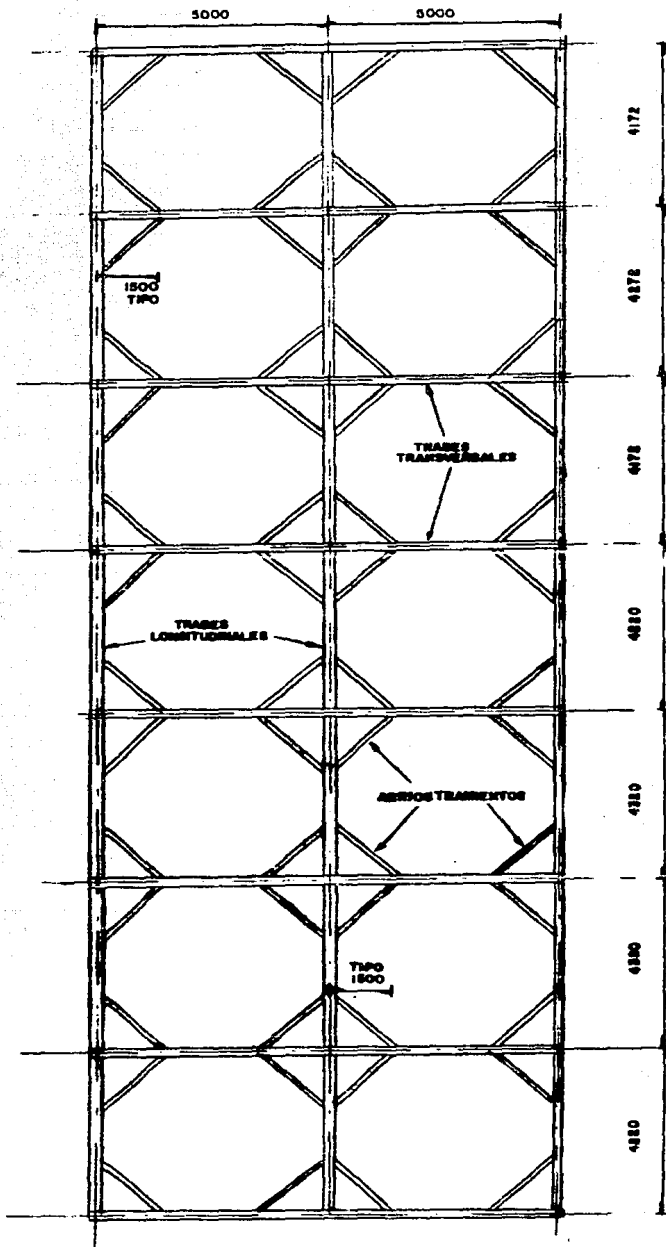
ESTRUCTURACION PLANTA EN ELEV. 113600
